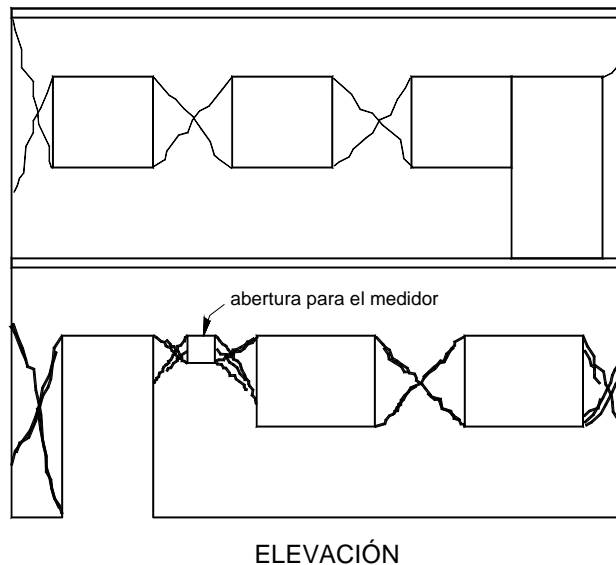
Geometría y patrón típico del agrietamiento en muros de fachada con aberturas
